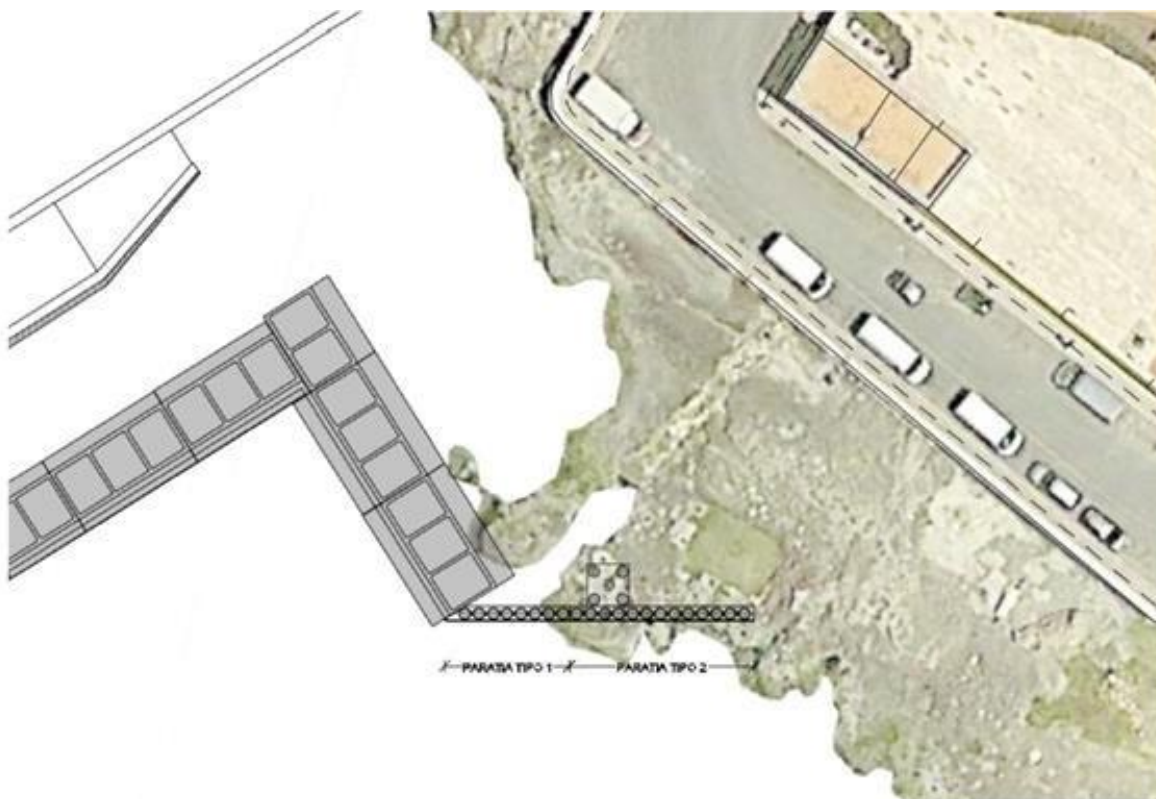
Paratia Tipo 1 e Tipo 2: sovrapposizione planimetria di progetto su ortofoto
